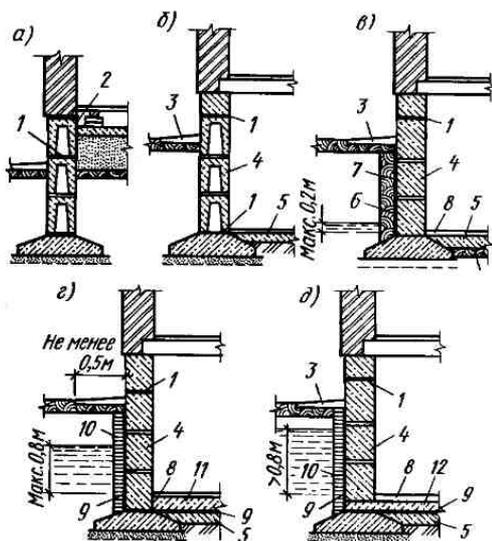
Изоляция здания от грунтовой влаги: а, б — гидроизоляция при отсутствии напора грунтовых вод (а — здание без подвала; на других рисунках — здания с подвалом); в, г, д — то же, при напоре грунтовых вод; 1 — горизонтальная гидроизоляция, 2 — то же, вертикальная, 3 — отмостка, 4 — стена подвала, 5 — бетонная подготовка, 6 — обмазка горячим битумом, 7 — мягкая жирная глина, 8 — чистый пол, 9 — гидроизоляционный ковер, 10 — защитная стенка, 11 — бетон, 12 — железобетонная плита
